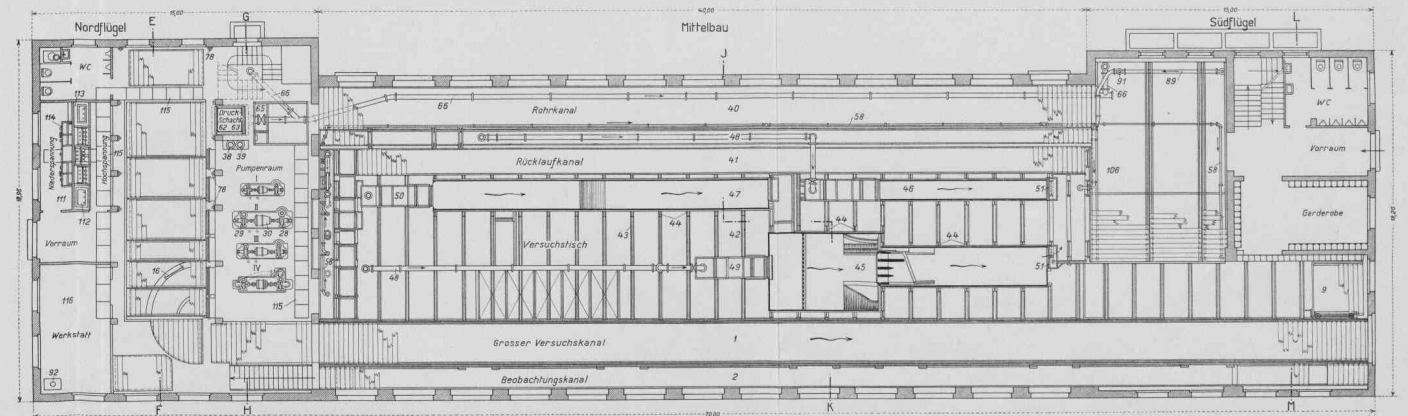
Grundriss des Erdgeschosses der Anstalt mit dem grossen Versuchsraum.
